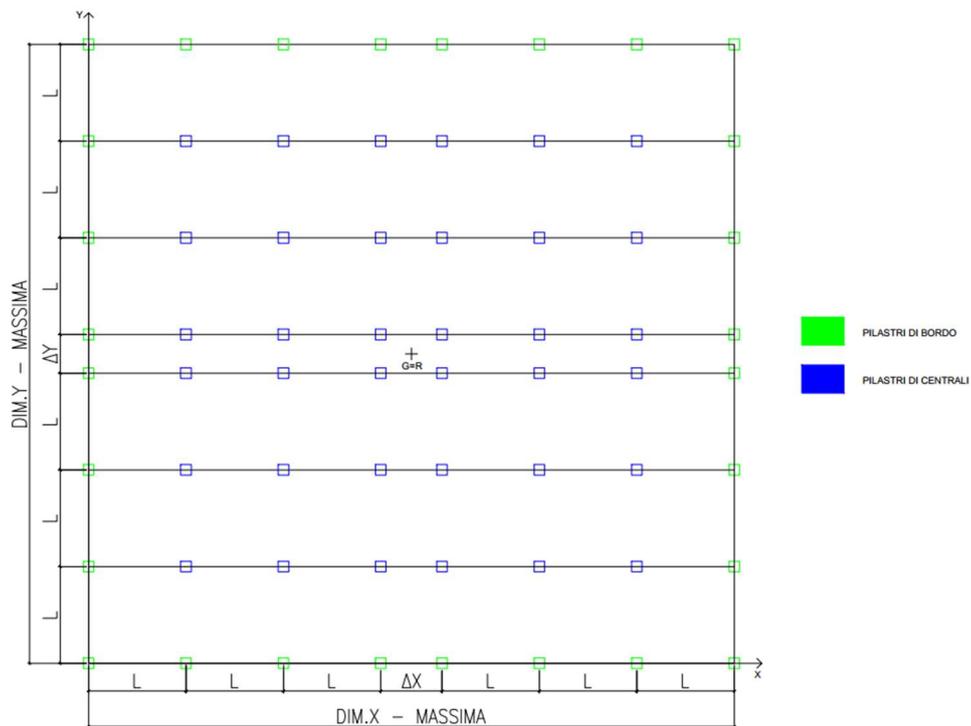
Planimetria piano tipo - modello speditivo virtuale
